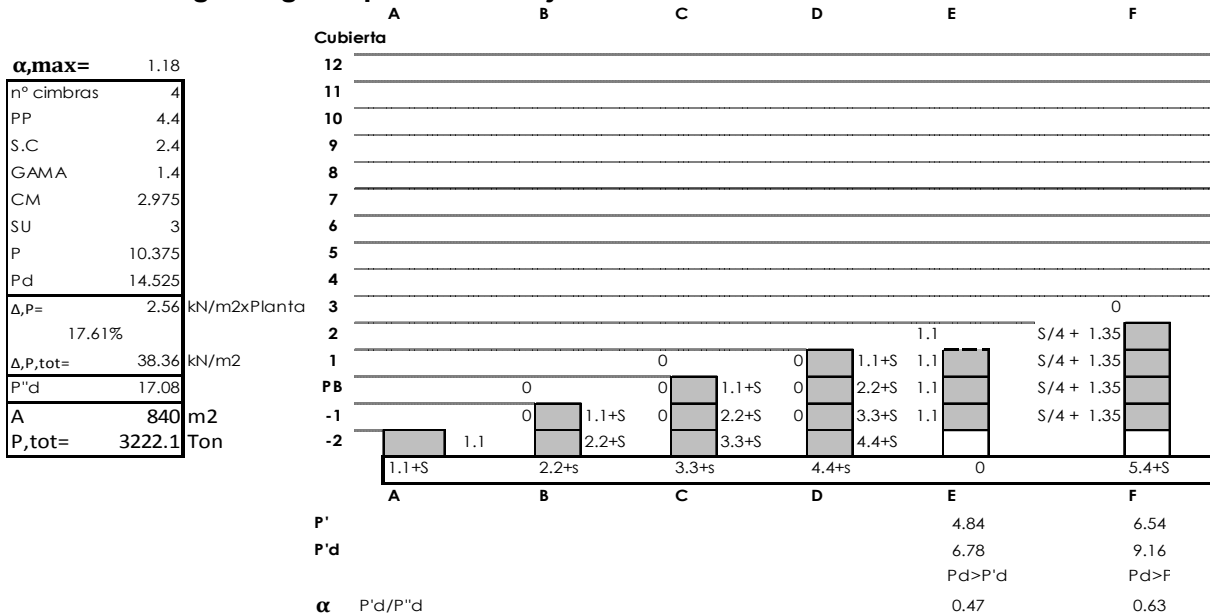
Proceso Constructivo. 4 Cimbras forjados de Losa Reticular. 1/4
